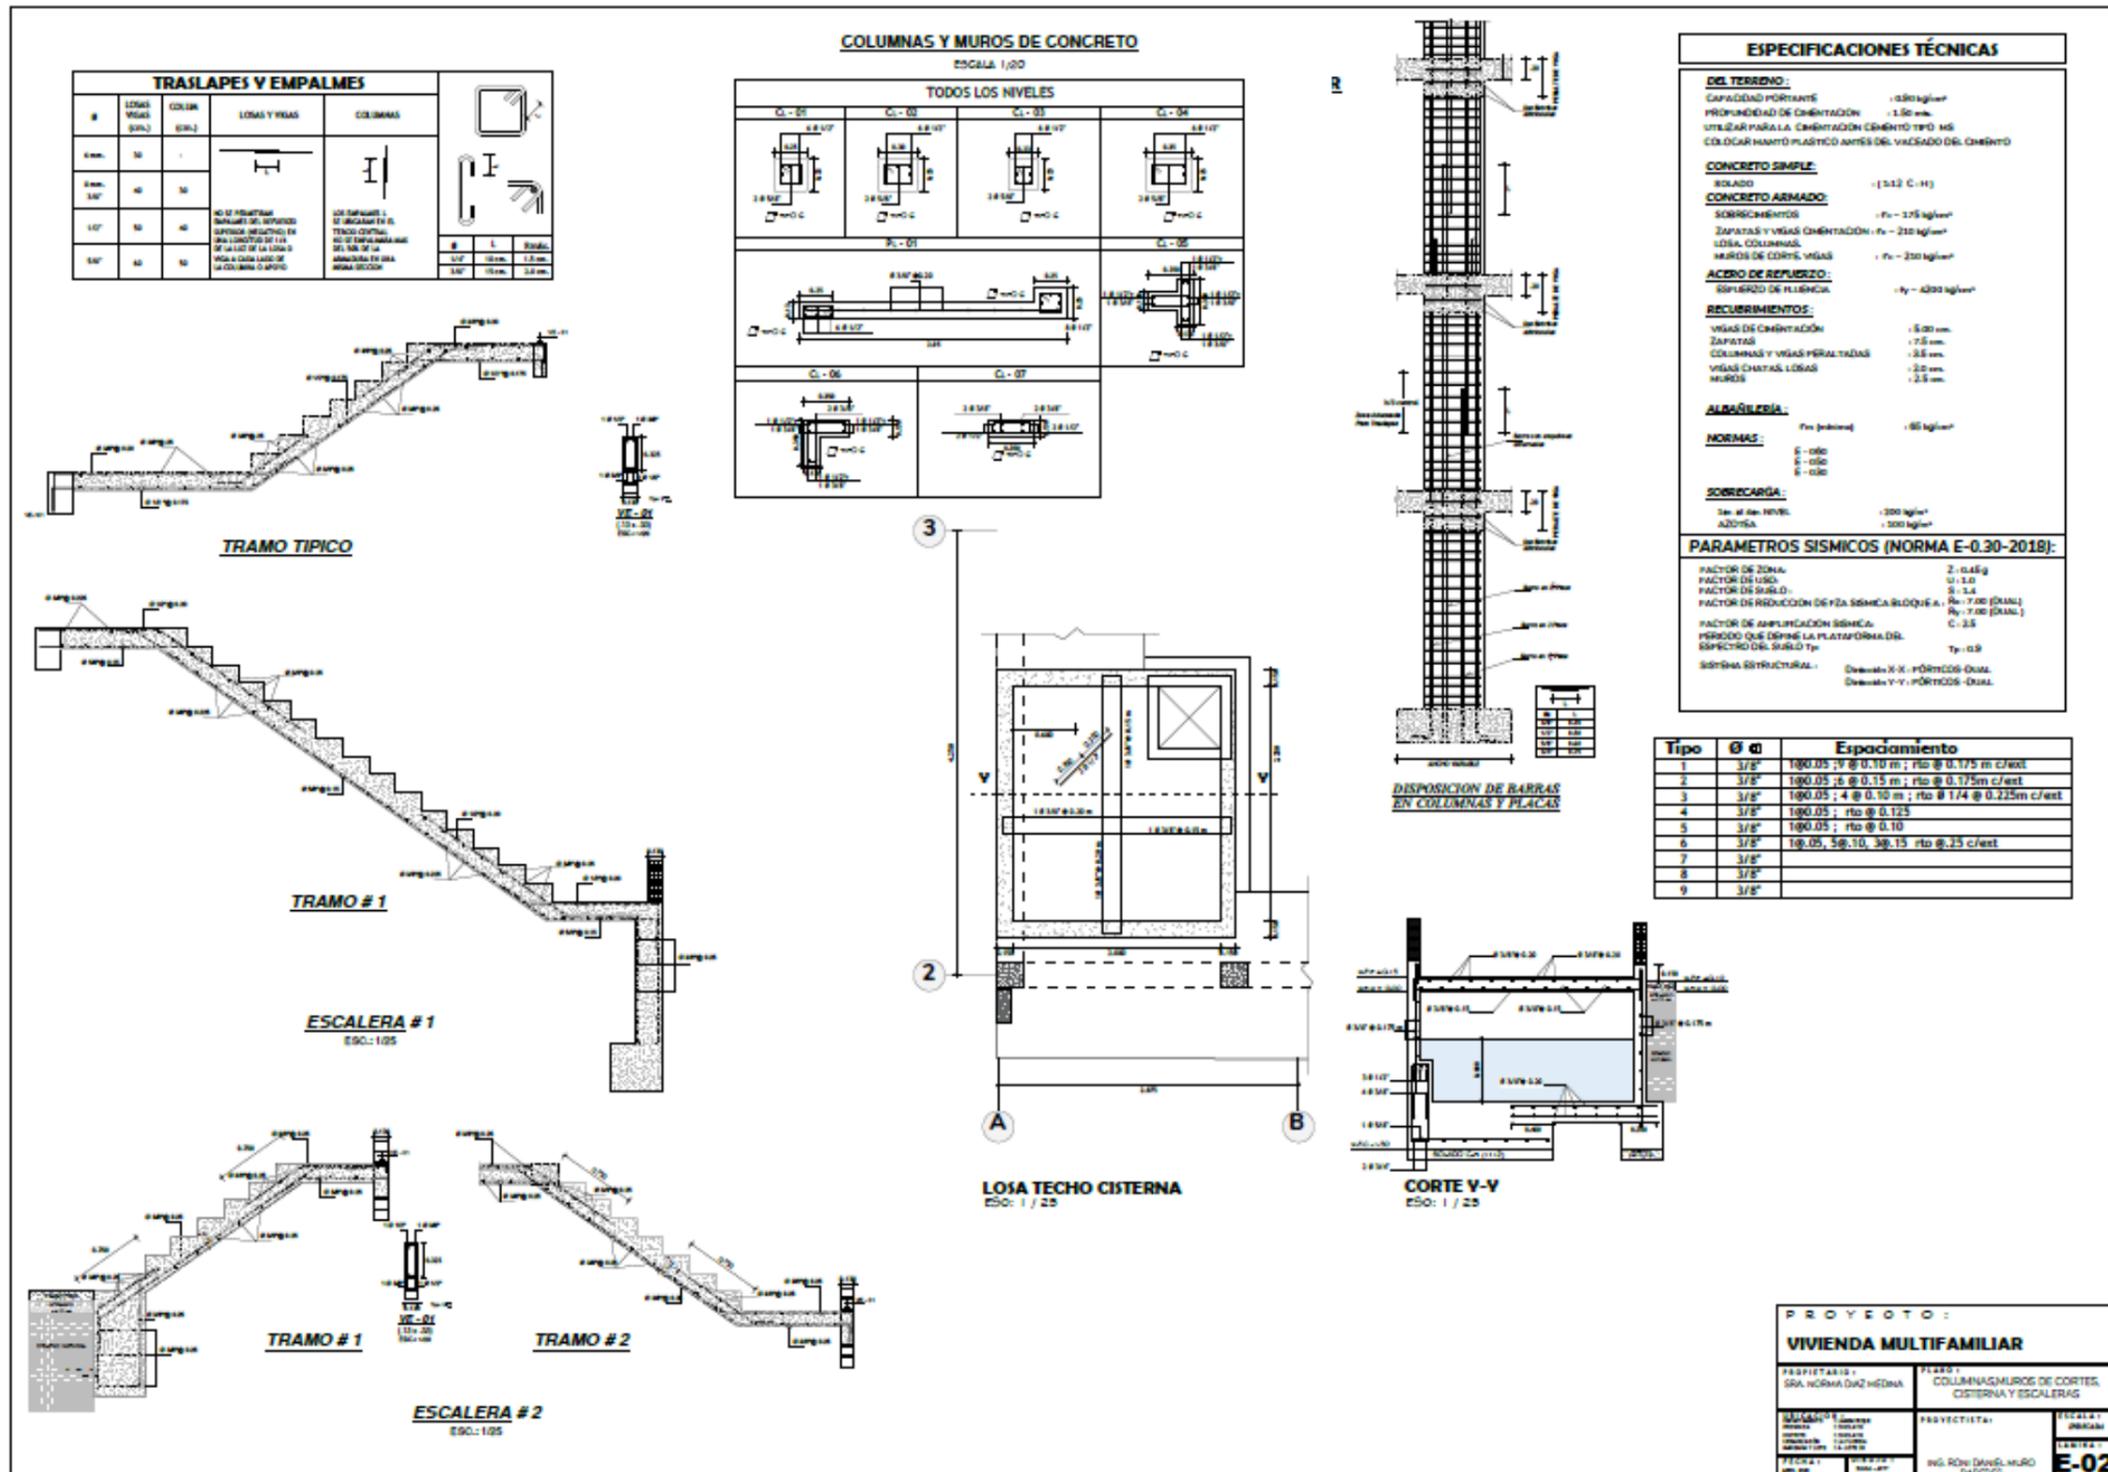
Plano de Detalles de Escaleras, Cisterna y Columnas
